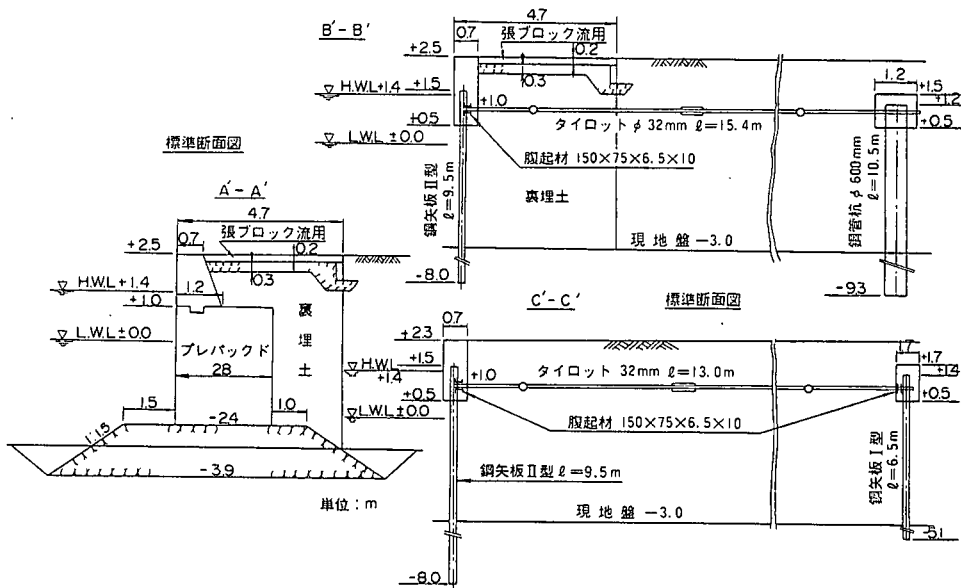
森港中央埠頭岸壁取付先端部標準断面図
